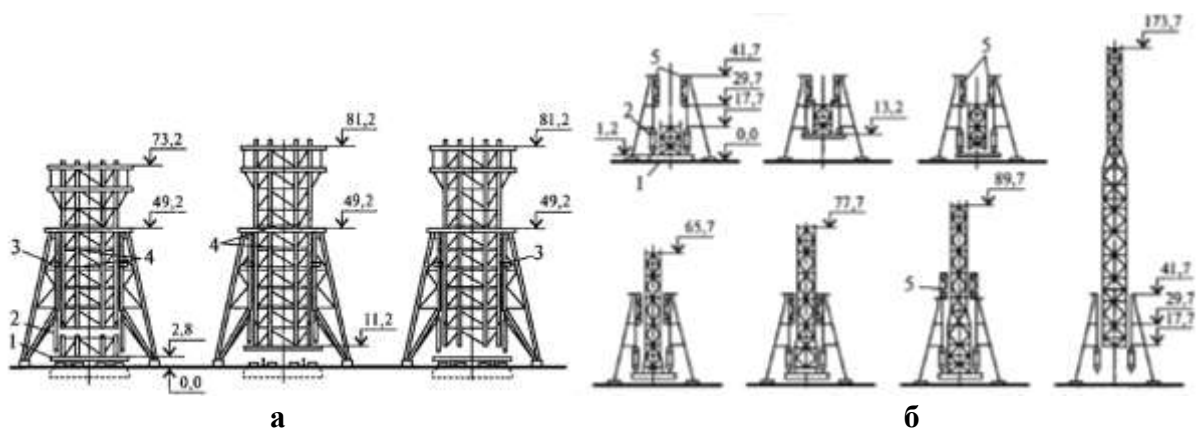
Схема монтажу веж підросуванням: а – монтаж типового блоку багатогранної вежі; б – послідовність монтажу висунутої частини з переломом перерізу;
